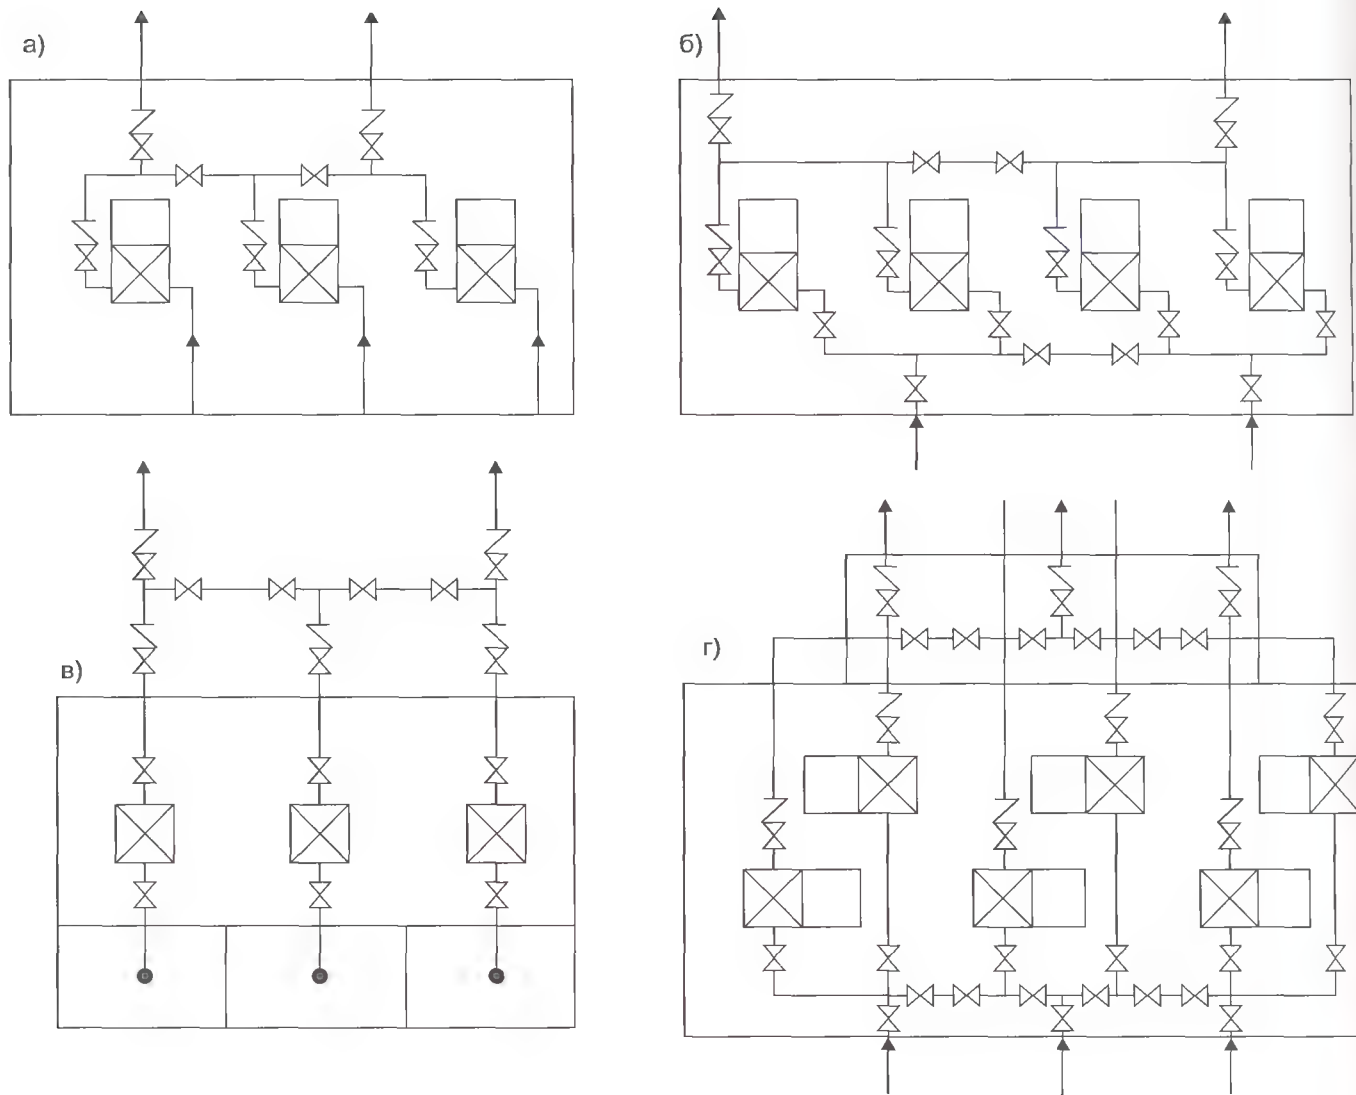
Схемы переключений на всасывающих и напорных трубопроводах
